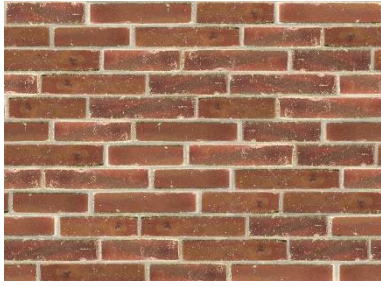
| Ziegelfassaden - Collage mit möglicher Farbigkeit und Struktur
